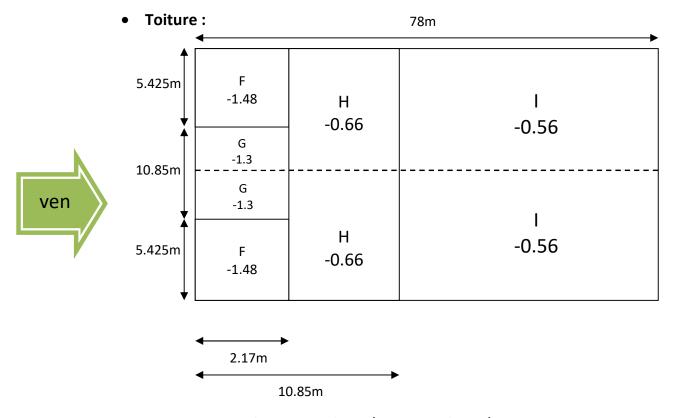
Cpe pour toiture (Vent sur pignon).
